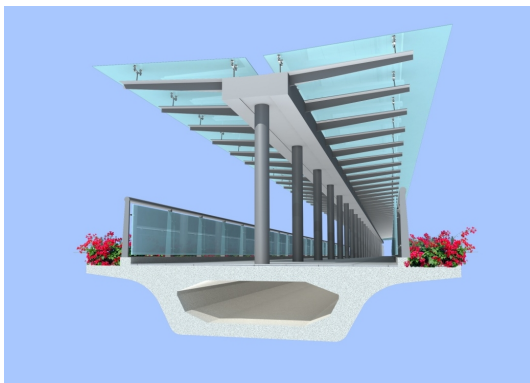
普通钢筋混凝土或预应力混凝土结构
